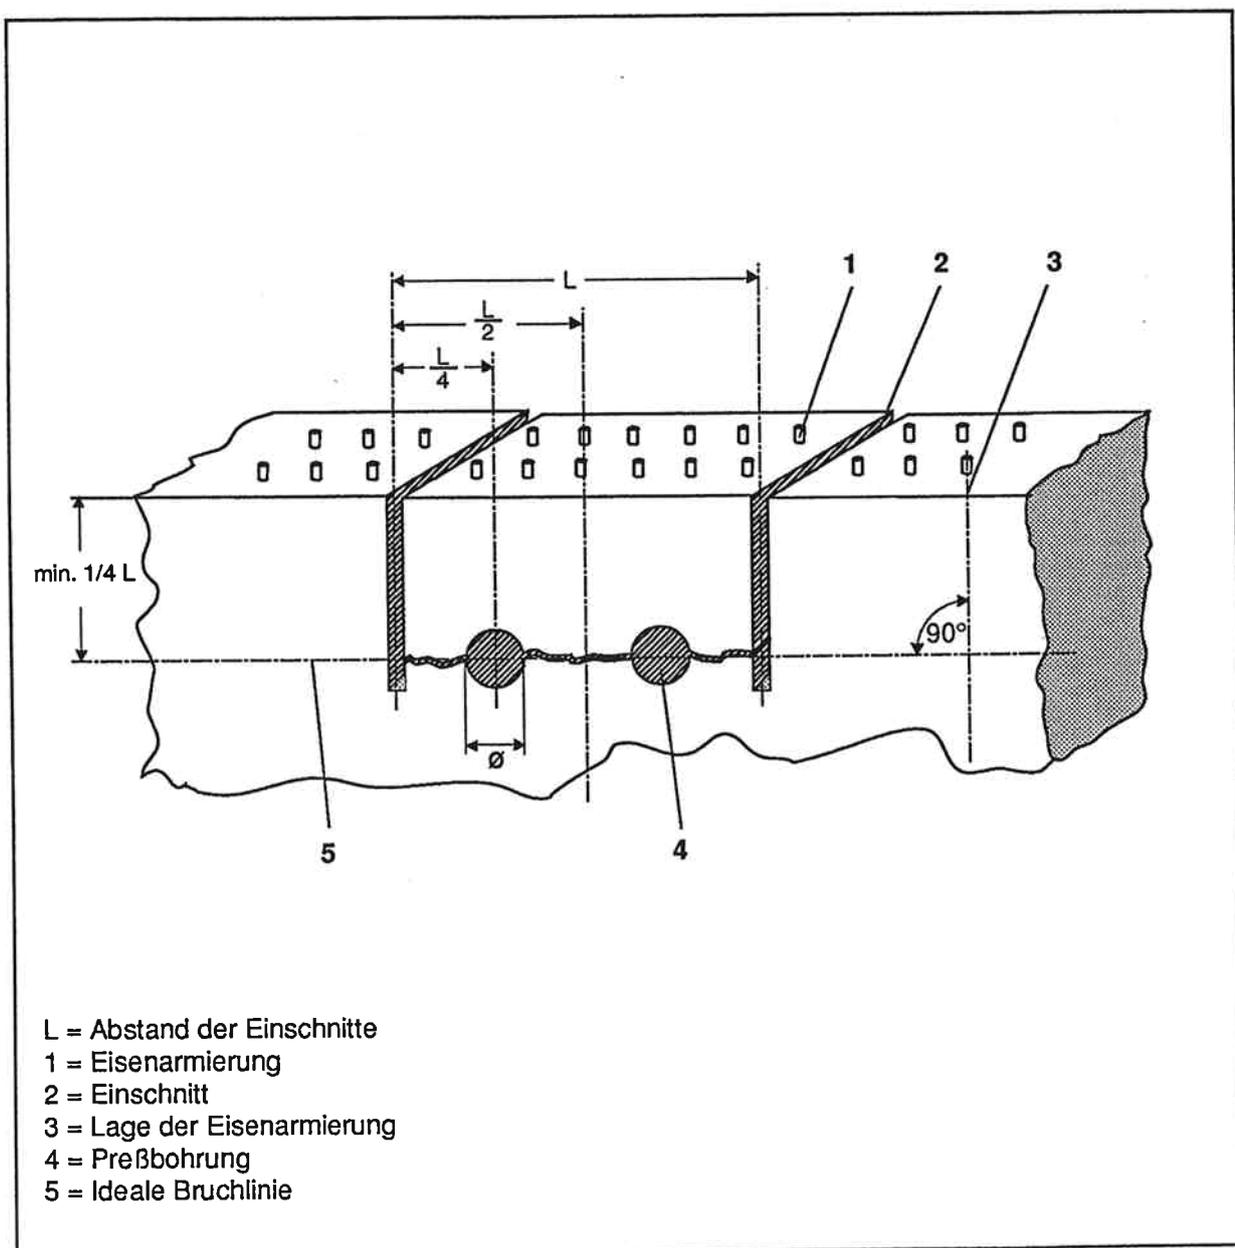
Preßbohrungen für 2 Preßwerkzeuge
